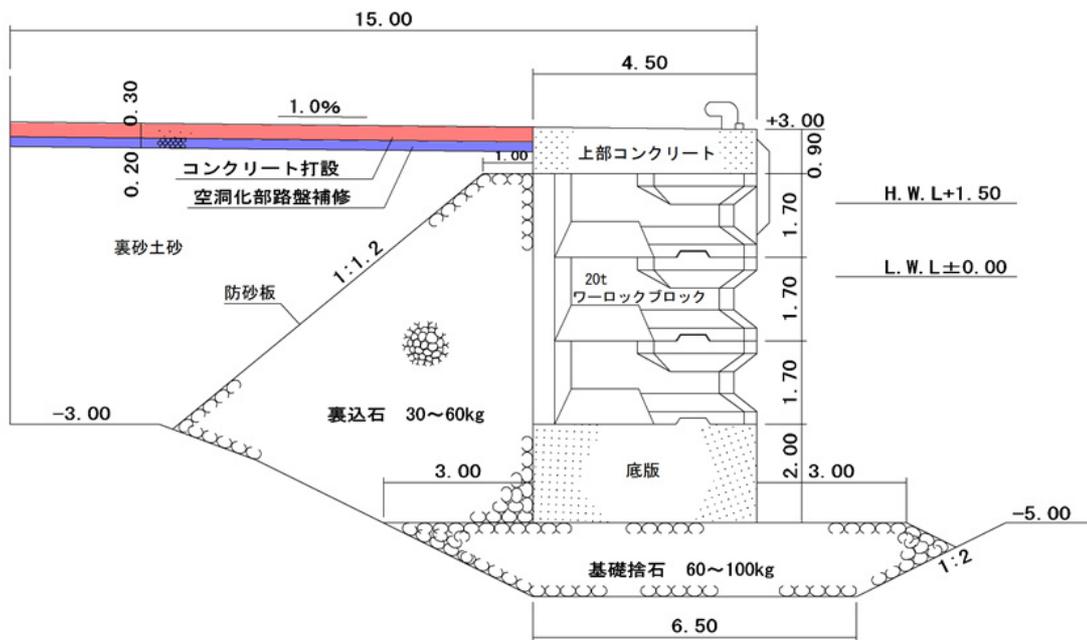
No.29 大洗港区_第1埠頭C物揚場(-2.0m) (水産ふ頭地区)の断面図(復旧後)
